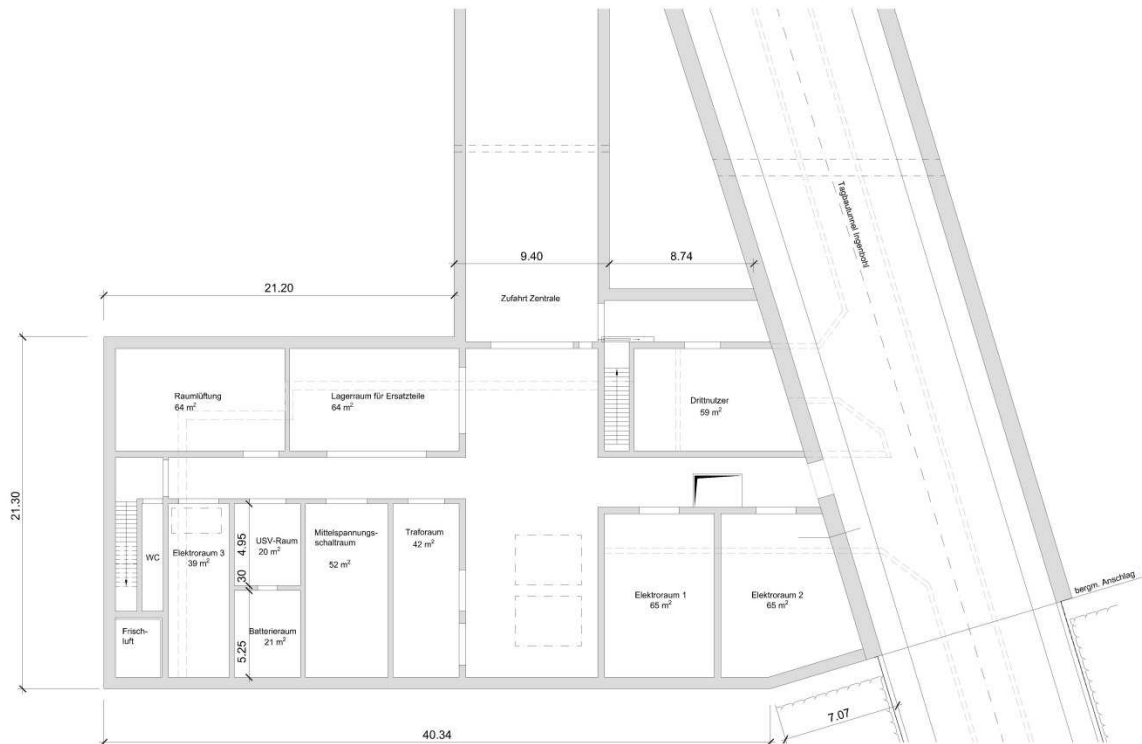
Grundriss EG, Lüftungszentrale Ingenbohl
